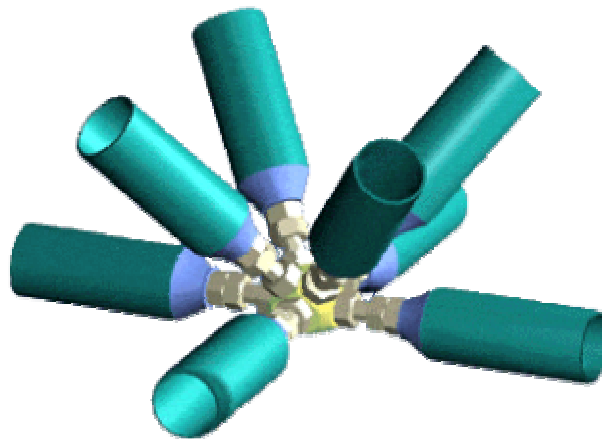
Sistema de ligação CUBOTTO – Itália ([www.vestrut.com](http://www.vestrut.com))
